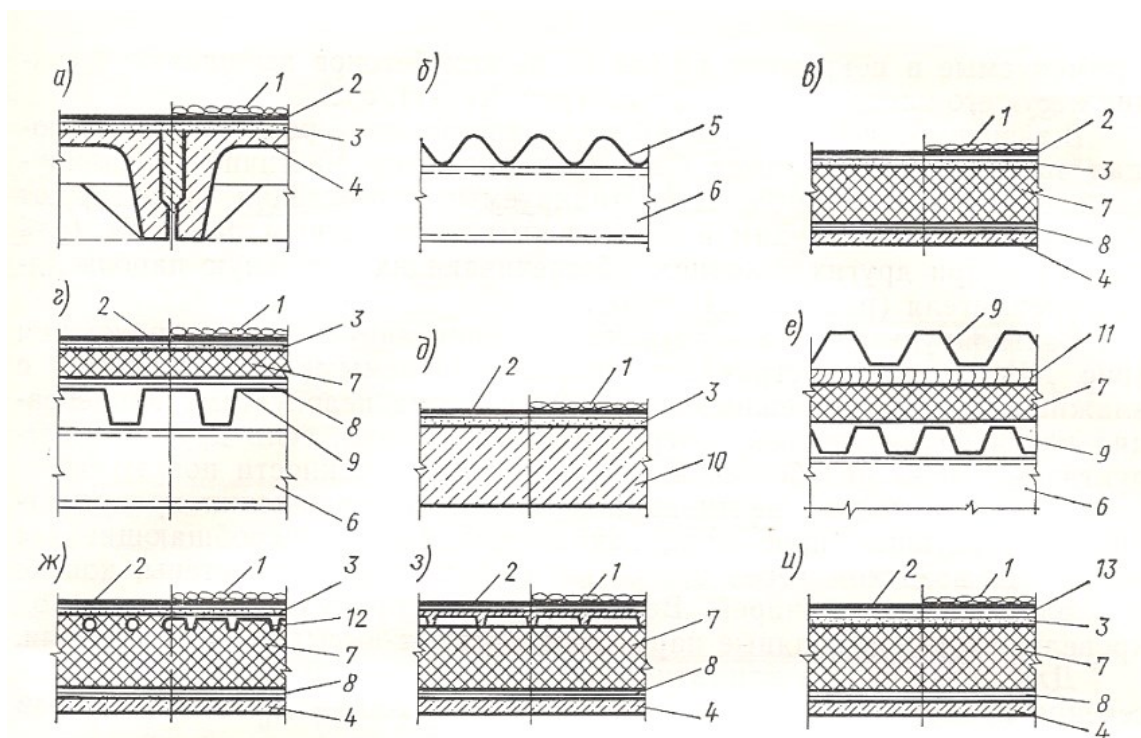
Основные типы кровельных покрытий производственных зданий: а-д) - невентилируемые; ж) - частично вентилируемые; е, з) - вентилируемые; и) - с диффузной прослойкой: 1- защитный слой; 2- кровельный ковер; 3- выравнивающий слой; 4- железобетонный настил; 5- асбестоцементные или металлические листы; 6- прогон; 7- утеплитель; 8- пароизоляция; 9- металлический профнастил; 10- легковесный настил; 11- деревянная рейка; 12- каналы или борозды; 13- перфорированный рулонный материал
